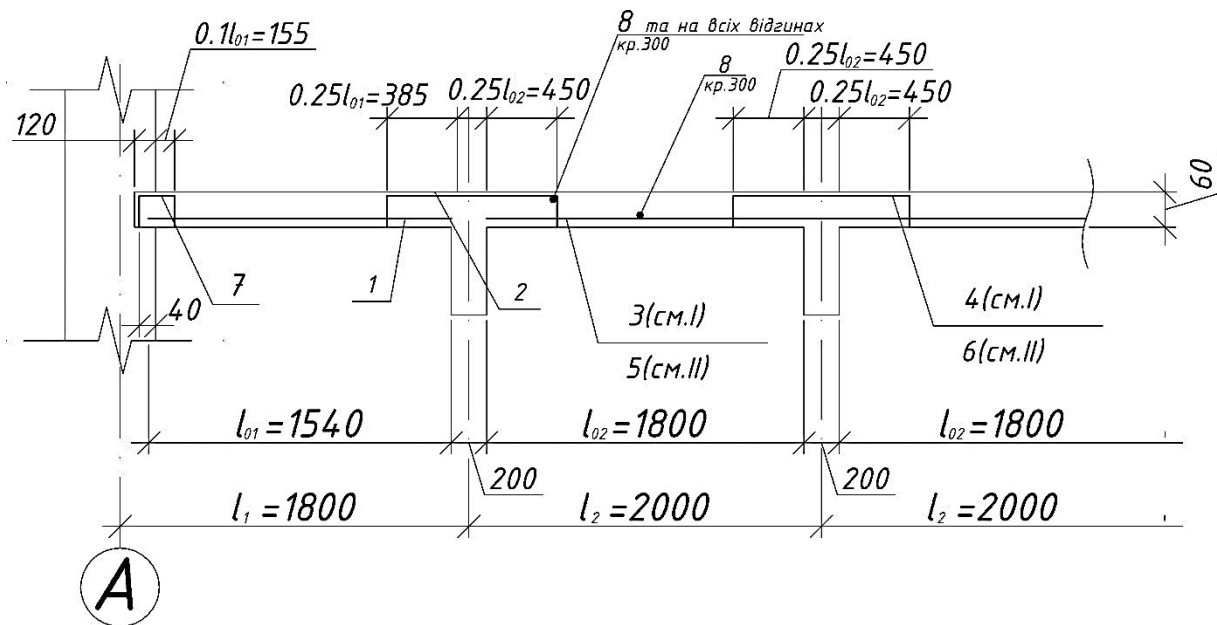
Армування плити в'язаними сітками (окремими стержнями) без відгинів
